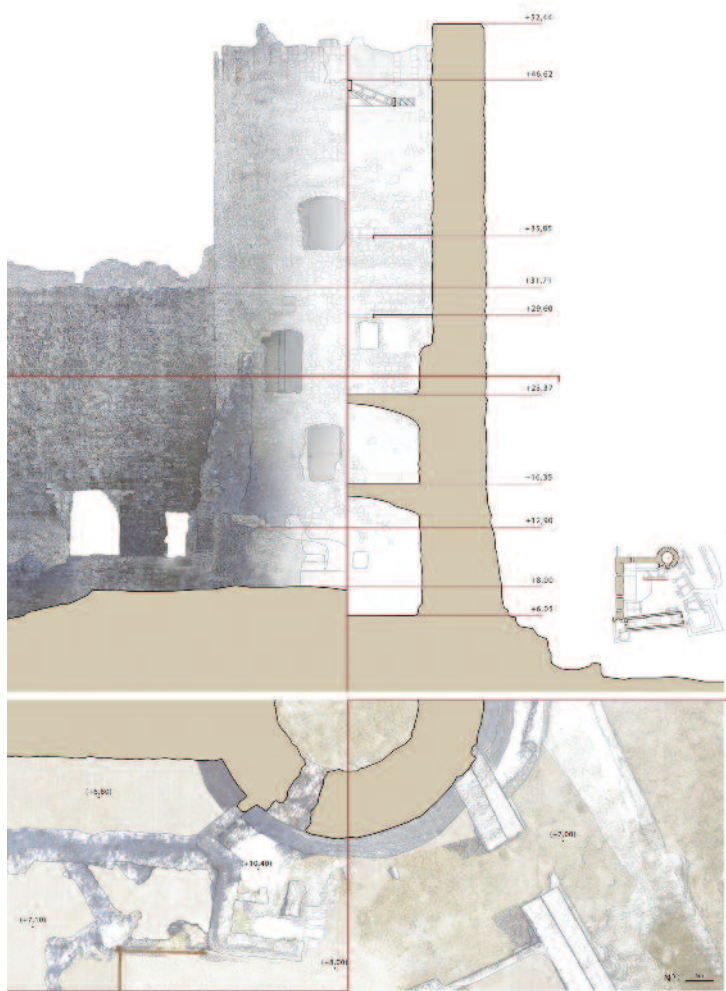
Restituzione finale delle operazioni di rilievo integrato effettuato nel sito di Avella nel luglio 2016. Particolare della torre angioina (mastio). Pianta a quota 24.70 m, prospetto est e sezione est-ovest.
